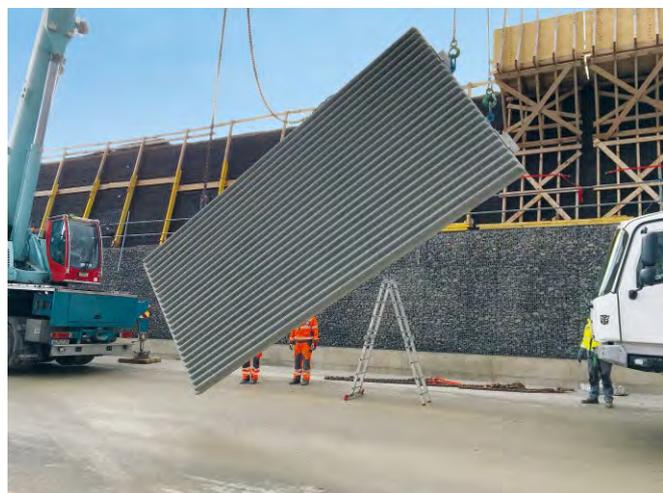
Die Elemente wurden an Ort und Stelle mit zwei Autokränen in die richtige Einbaulage gedreht und vertikal montiert.
